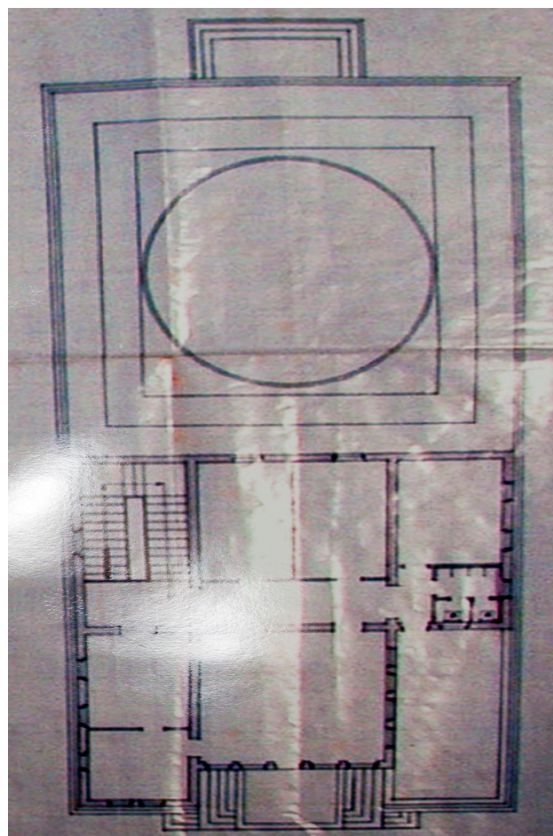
Sinagoga Mekor Haim (Porto): Planta
